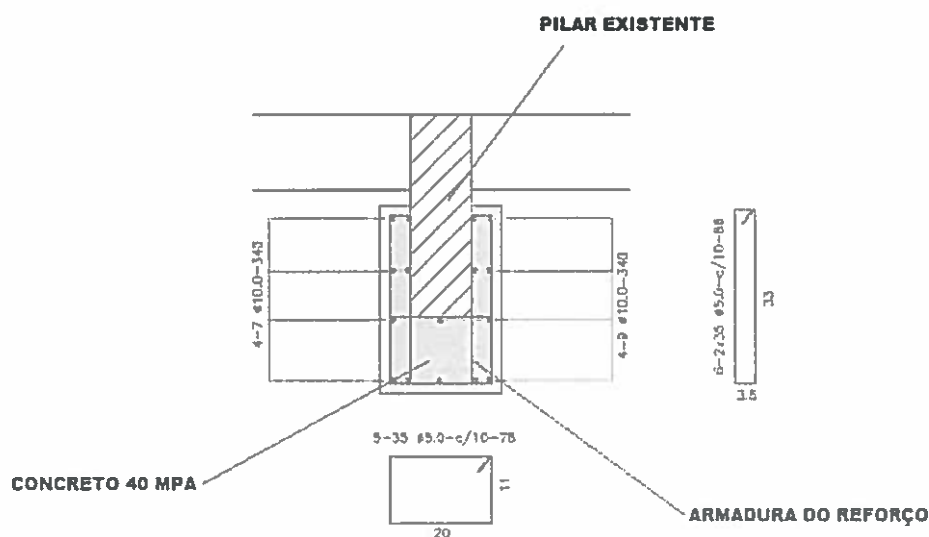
Esquema de Reforço dos pilares entre alvenarias
